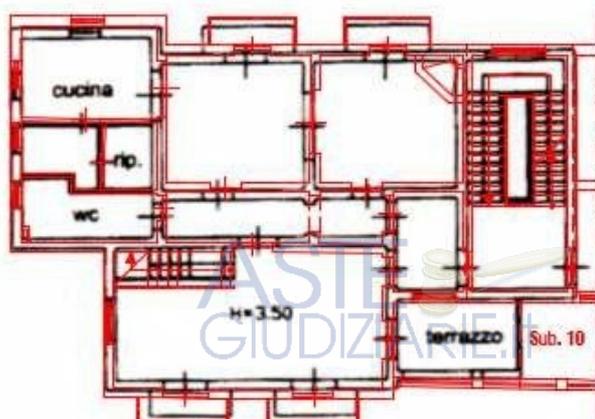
Planimetrie catastali attuali dei sub 9 e 10 di piano secondo
